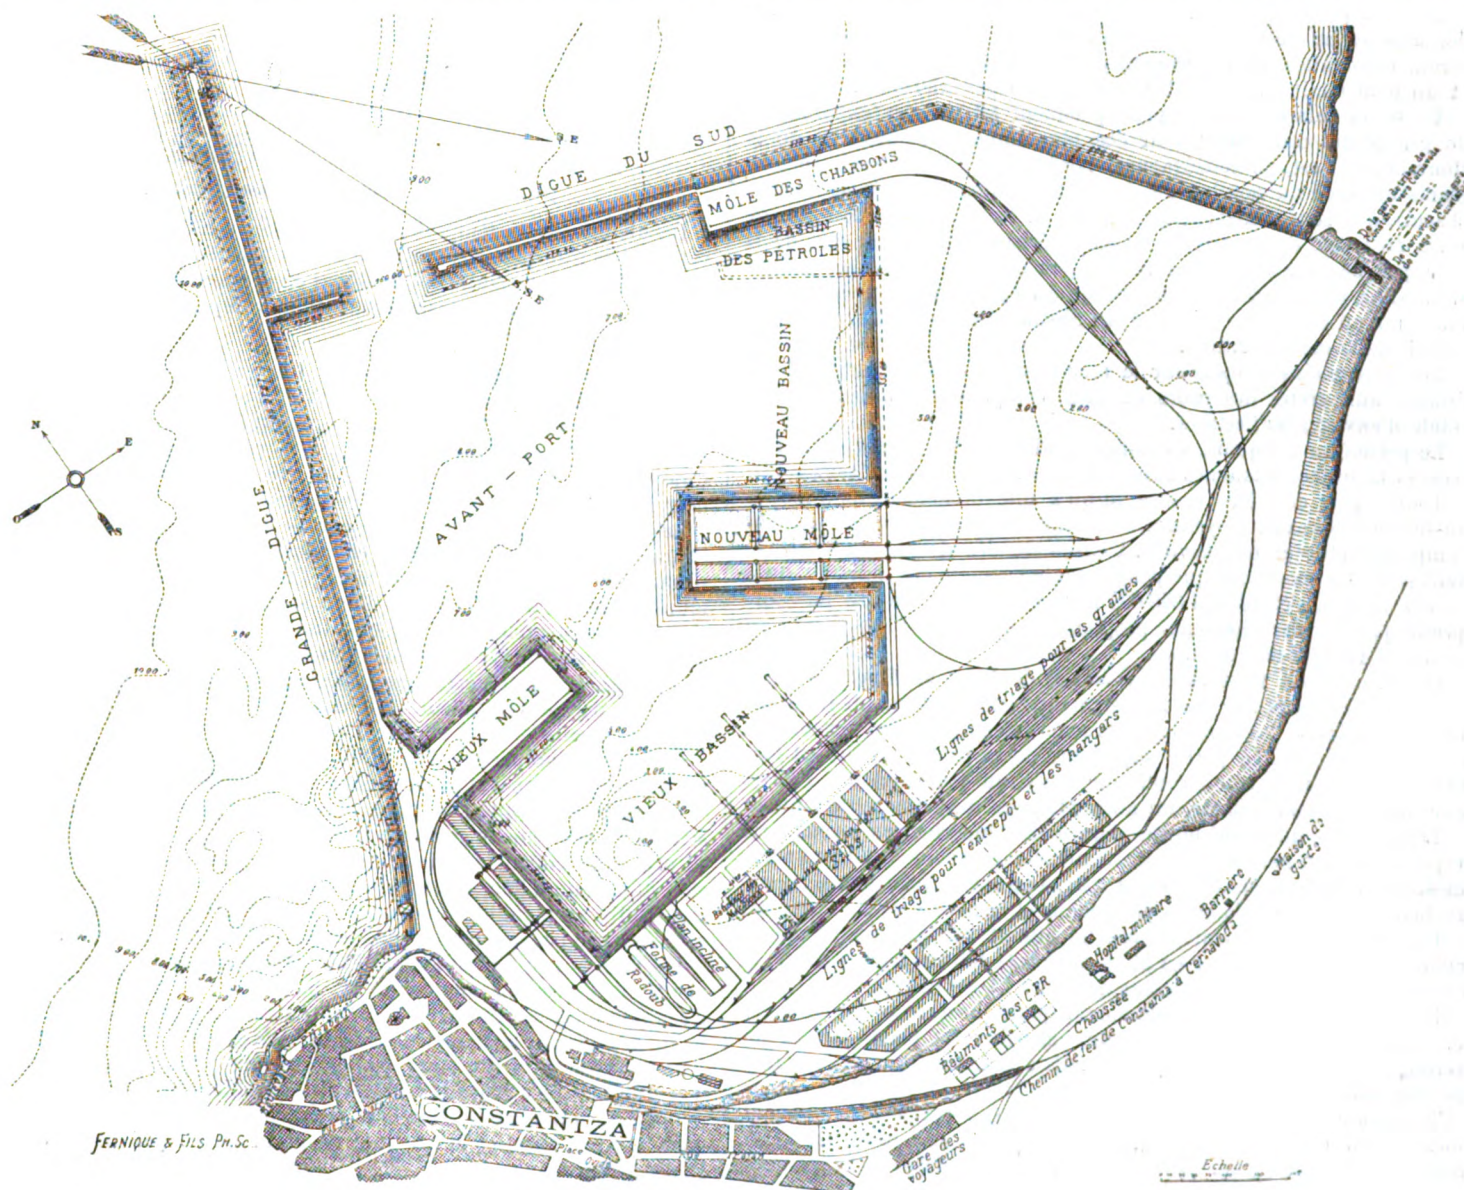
Plan du nouveau port de Constantza, sur la mer Noire.
